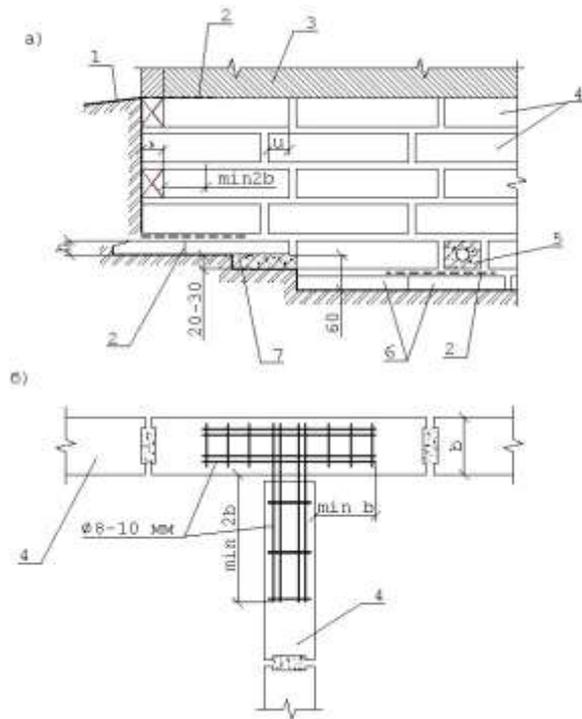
Перевязка наружных и внутренних стен: блоками (а); арматурными сетками (б):
